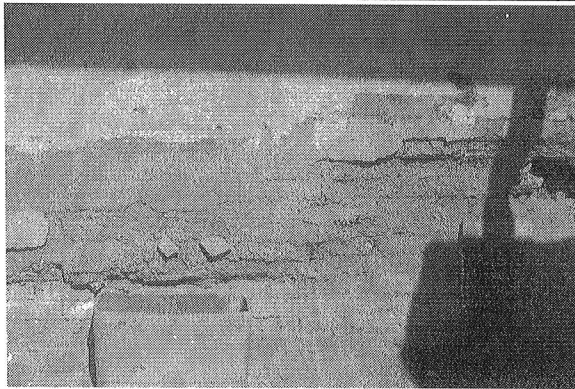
Muros de la construcción de la zona posterior deteriorados.
